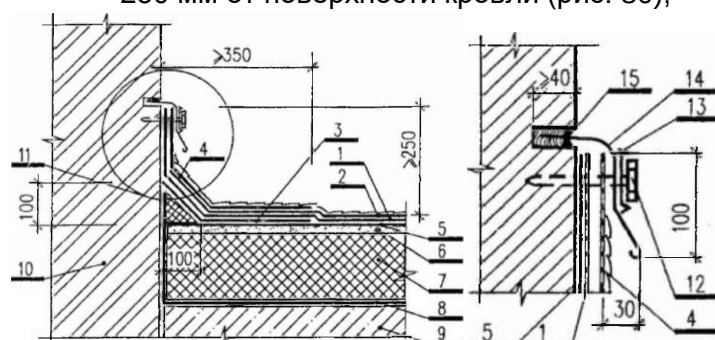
Примыкание двухслойной кровли с механическим креплением фартука в штрабе при сплошной наклейке водоизоляционного ковра
